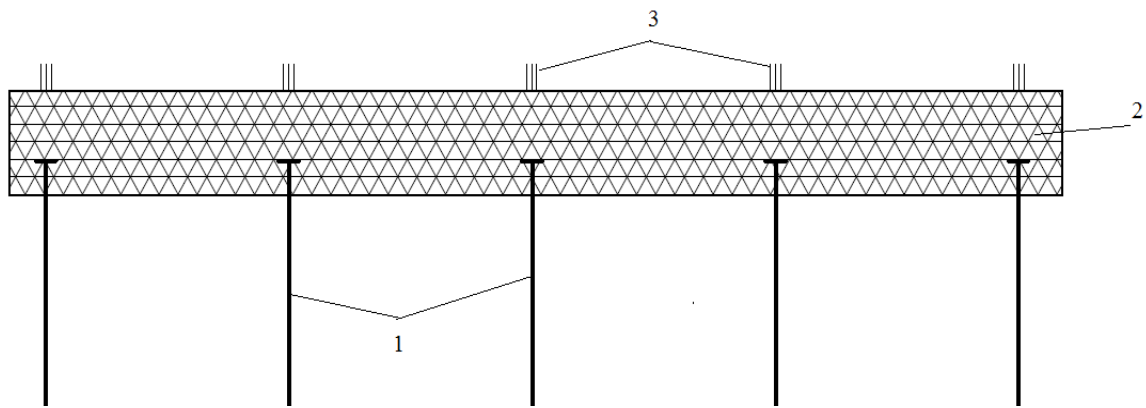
Розріз фундаменту: 1 – палі; 2 – арматурний каркас залитий бетоном (плита фундаменту); 3 – виступаюча арматура під несучі колони
